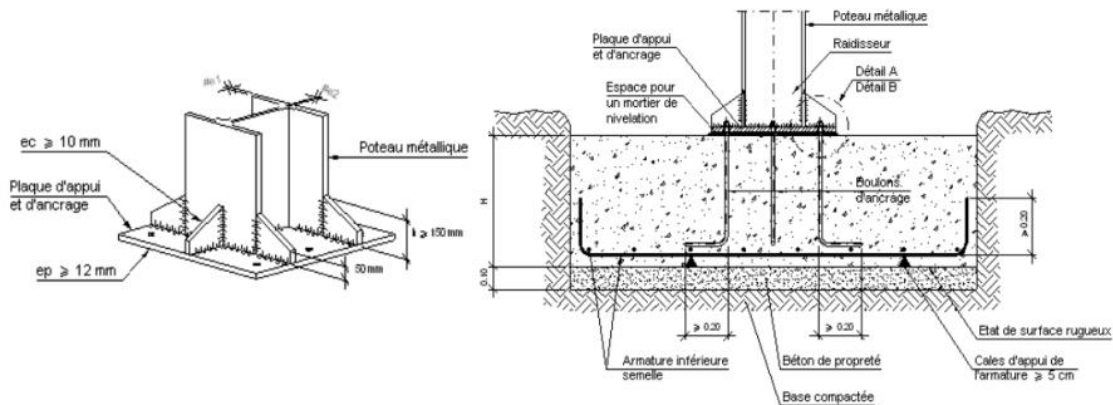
Détail de l'assemblage et d'encrage du poteau avec les fondations
